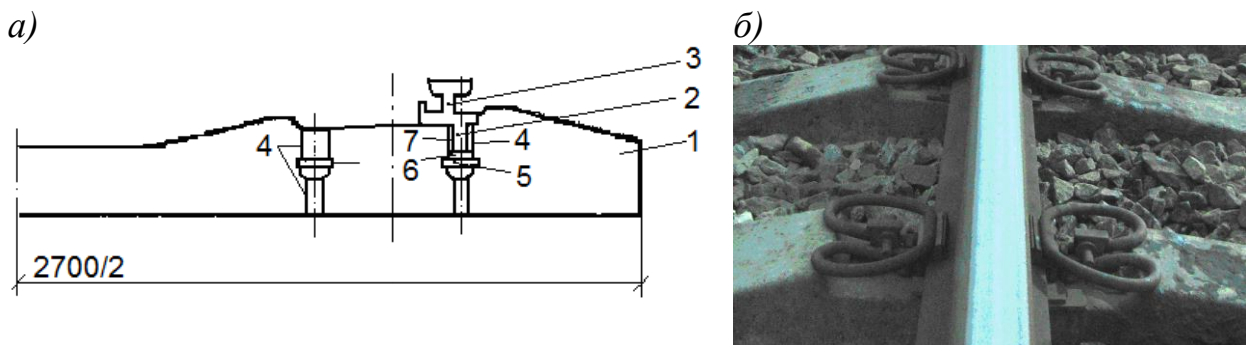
Захист конструкцій від електрокорозії за допомогою рейкового скріплення типу УС-1 (PRS-4) з анкером на сірчаній мастиці з наповнювачем: *а)* залізобетонна шпала з анкером скріплення; *б)* рейкове скріплення УС-1 (PRS-4) на дослідній ділянці електрифікованої колії Південної залізниці: 1 – залізобетонна шпала; 2 – хвостовик анкера; 3 – головка анкера; 4 – отвір у шпалі під закладний болт; 5 – закладна шайба; 6 – прокладка; 7 – затверділа сірчана мастика
